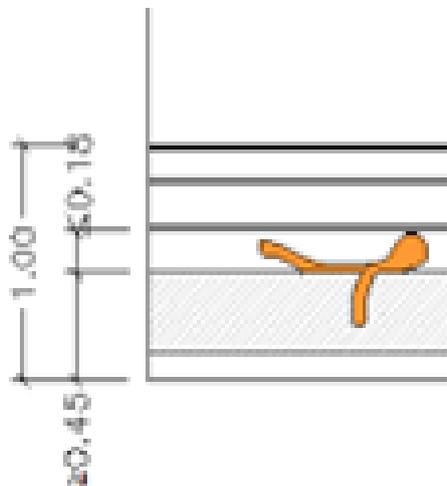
Transposição por entre os elementos do preenchimento da guarda (criança passa entre os elementos)
